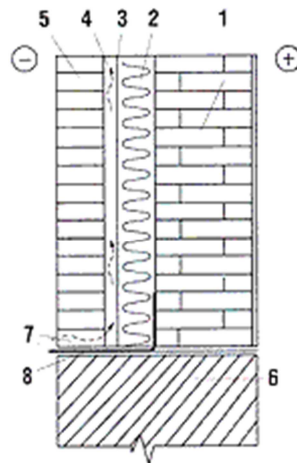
Схема устройства воздушной прослойки и продухов: 1 – утепляемая стена; 2 – утеплитель; 3 – ветрозащитная паропроницаемая мембрана; 4 – воздушная прослойка; 5 – облицовка из кирпича или камня; 6 – фундамент; 7 – вентиляционный продух; 8 – гидроизоляционный материал
